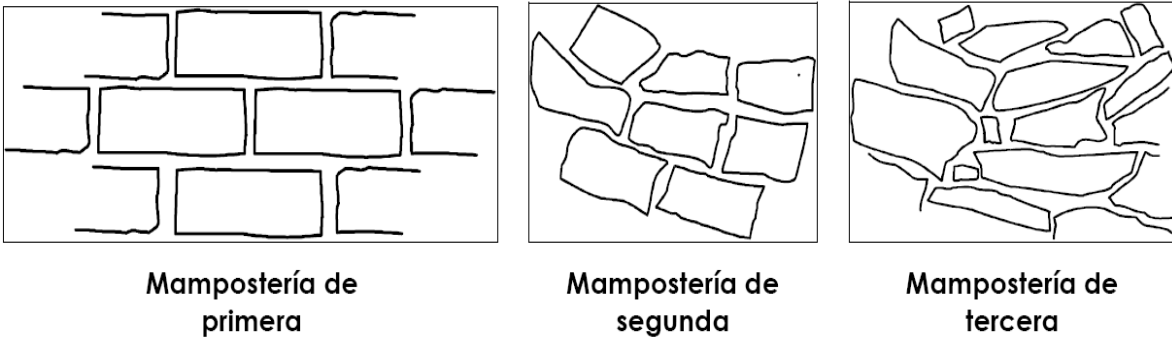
Tipos de mampostería de piedras naturales (Fuente: SMIE, 2003; 58).
